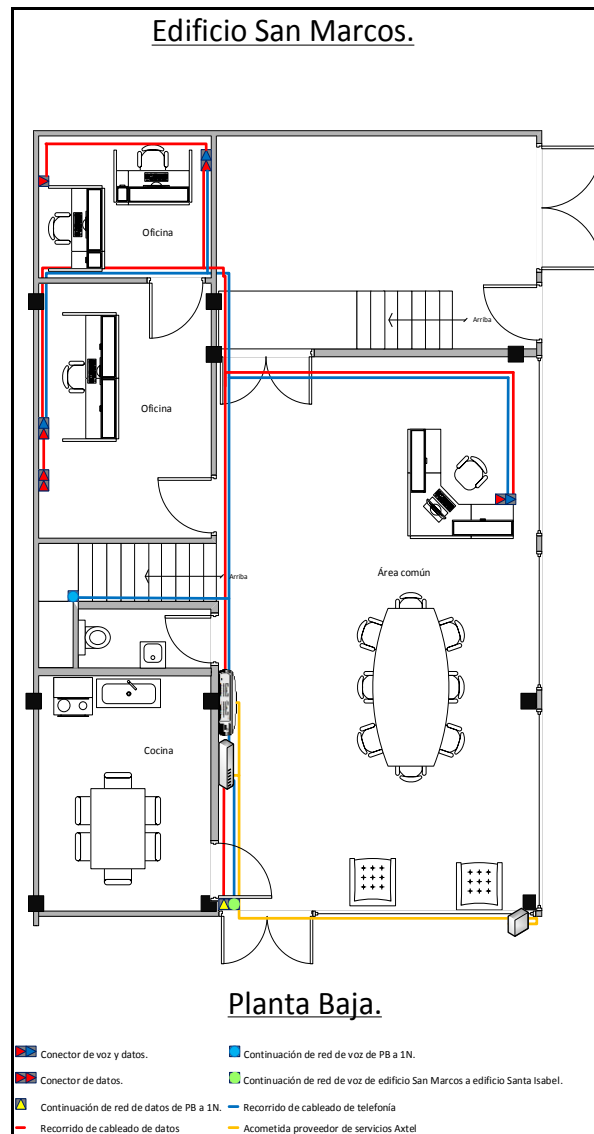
Trayectoria de cableado, edificio San Marcos PB. (Mateos, 2017) Recorrido del cableado en las oficinas de la PB, desde el switch 3COM hasta las estaciones de trabajo y los puntos en los cuales el cableado llega proveniente de edificio de Santa Isabel, así como el que sube al primer piso.
